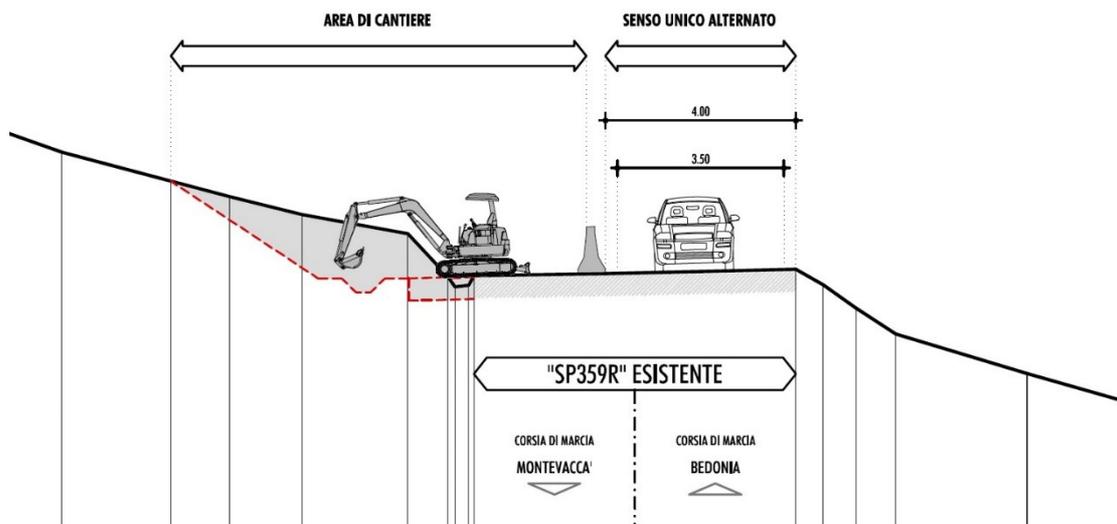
TRATTO 1, FASE 1: TRAFFICO SU CORSIA DI VALLE (ESTRATTO DALL'ELAB. PD.04.04)
